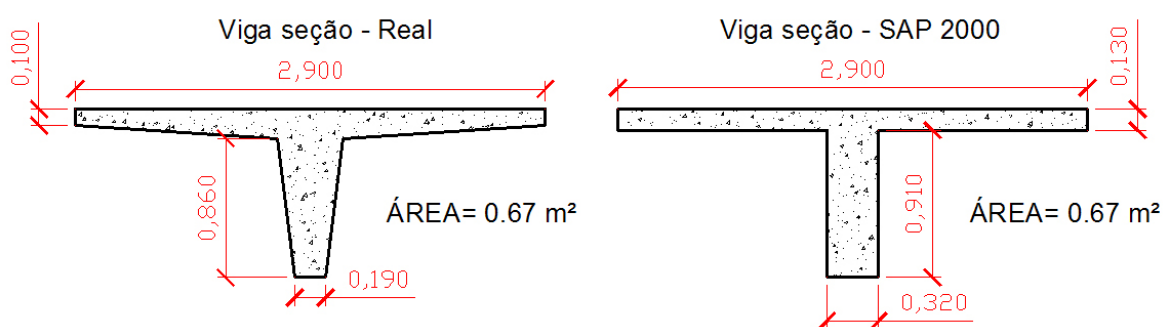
Seções transversais de viga da ala dos laboratórios (AUTOCAD, 2007 - dimensões em metros)
